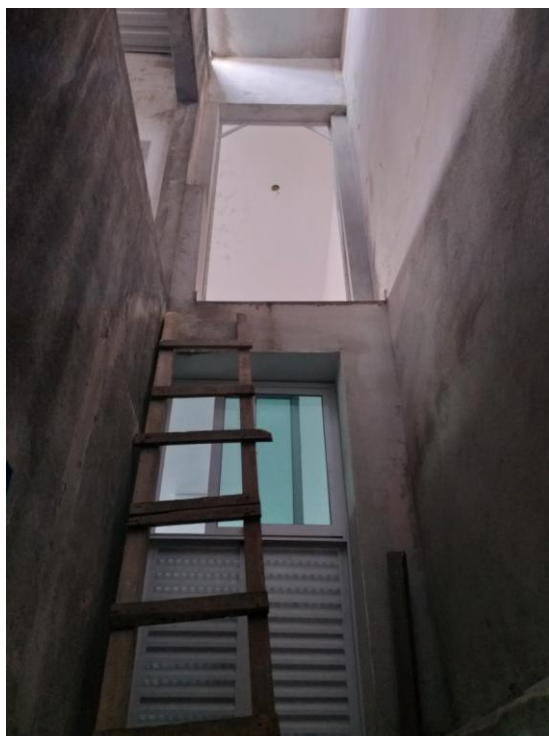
Vista do Acesso precário ao 1º Pavimento
